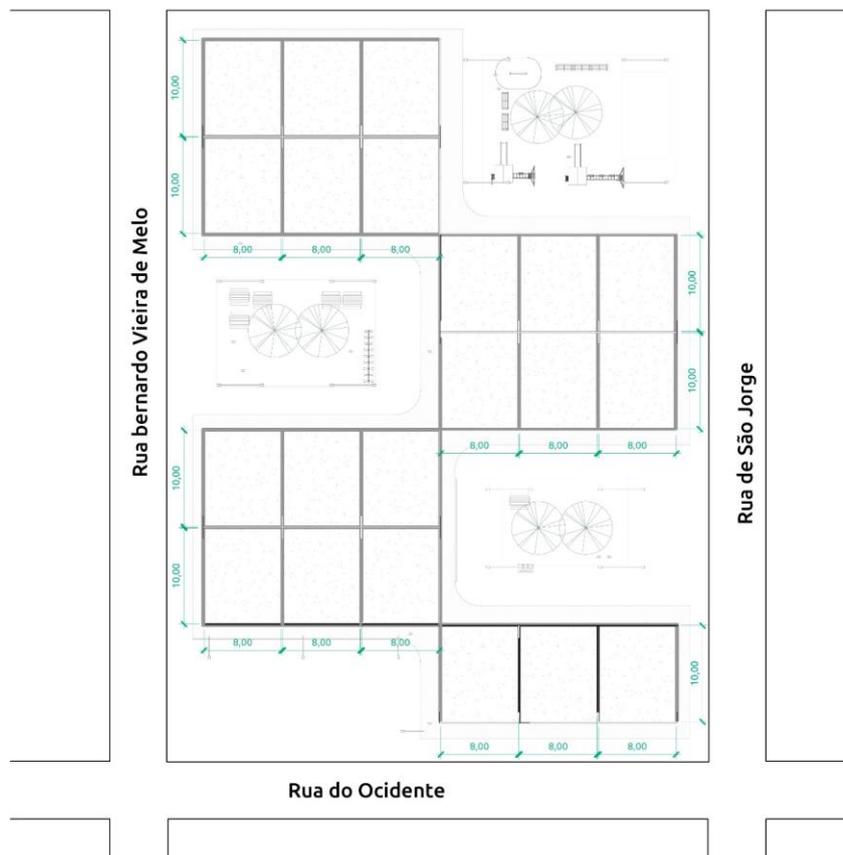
Planta de situação da quadra 46 – Comunidade do Pilar
